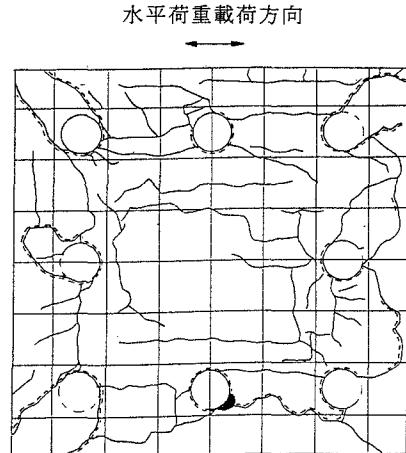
供試体下面のひび割れ状況(ケ-3)
